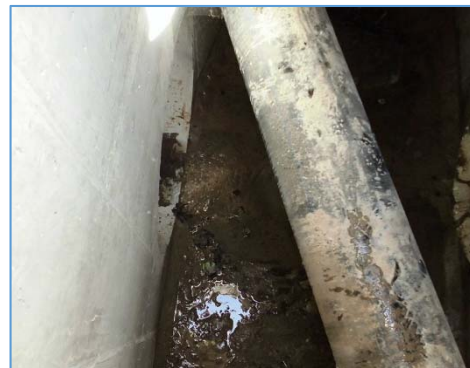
Detalle salida pluviales red Dorada 1 en zona de Pescaderías.
